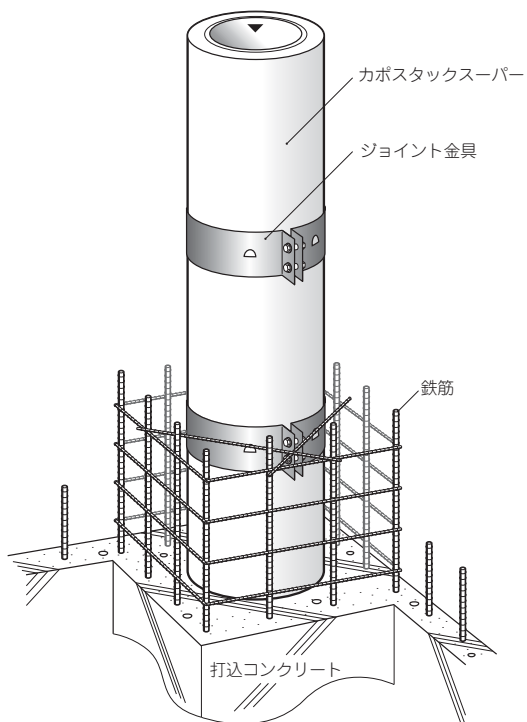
カポスタックスーパー鉄筋コンクリート造煙突施工図
